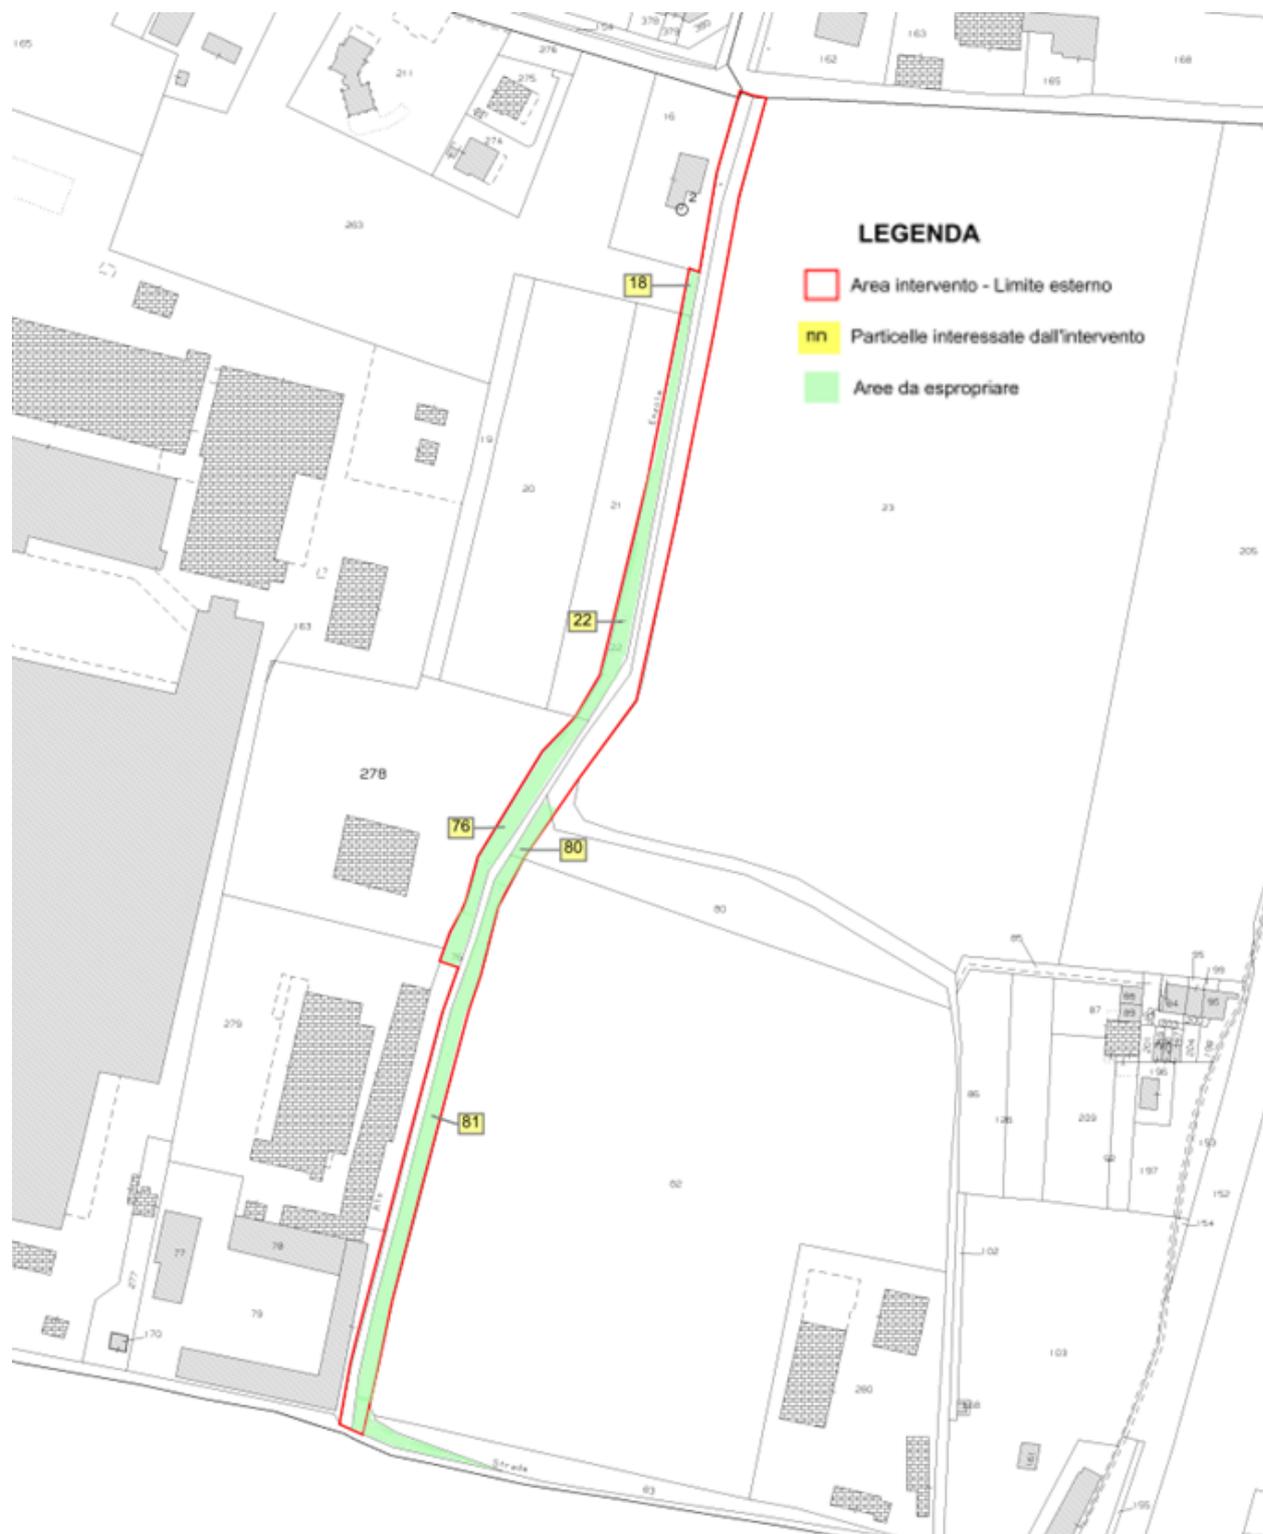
PLANIMETRIA CATASTALE COMUNE DI BIBBIANO (FG 36) CON INDICAZIONE DEI TERRENI OCCUPATI DALLE OPERE
